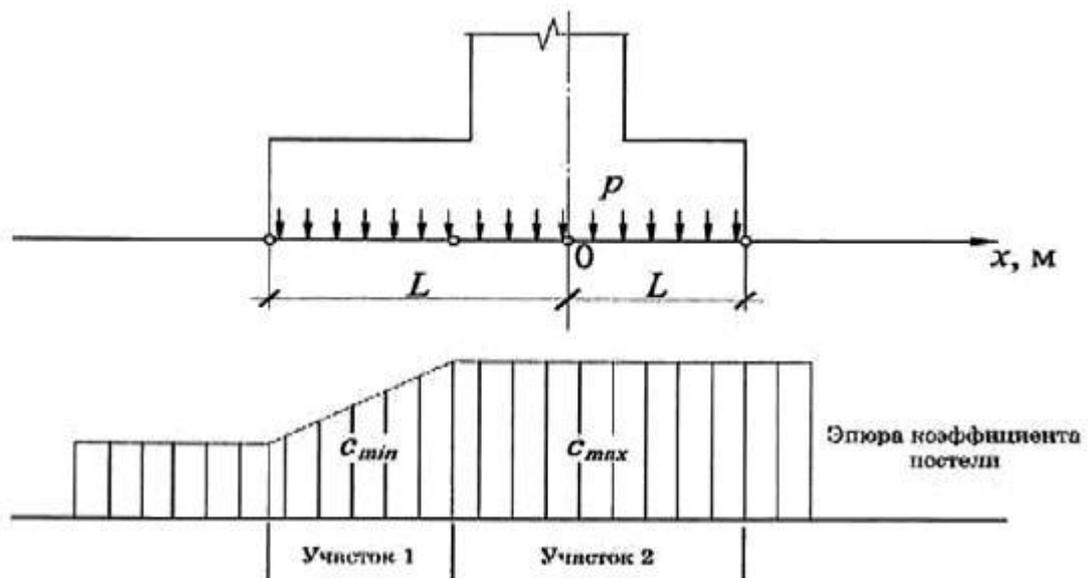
Схема для расчета деформаций засоленного грунта при горизонтальной фильтрации
